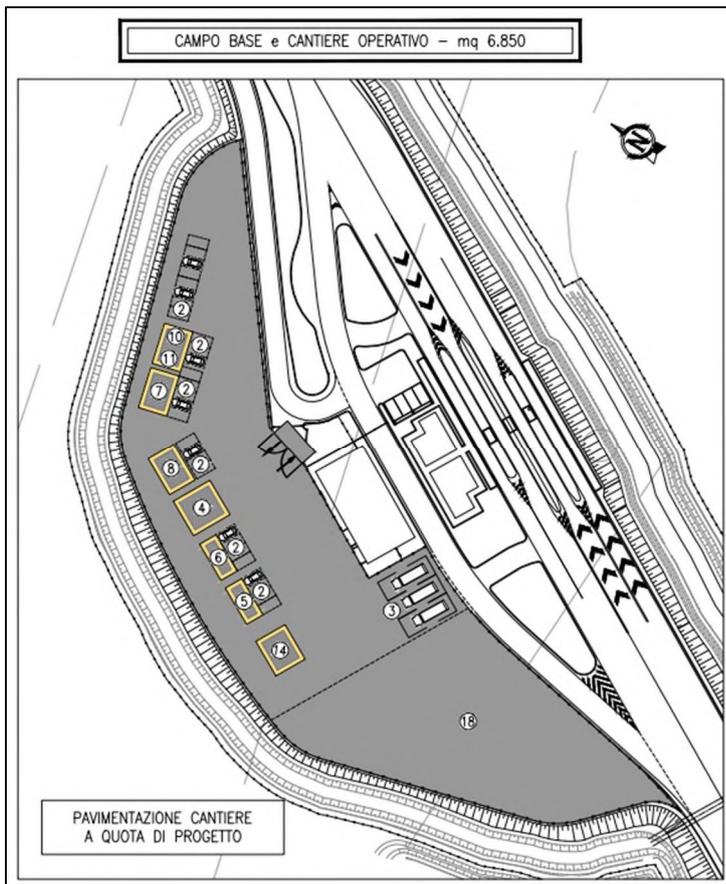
Dettaglio dell'area di cantiere e della relativa pavimentazione (da CNT0211)
